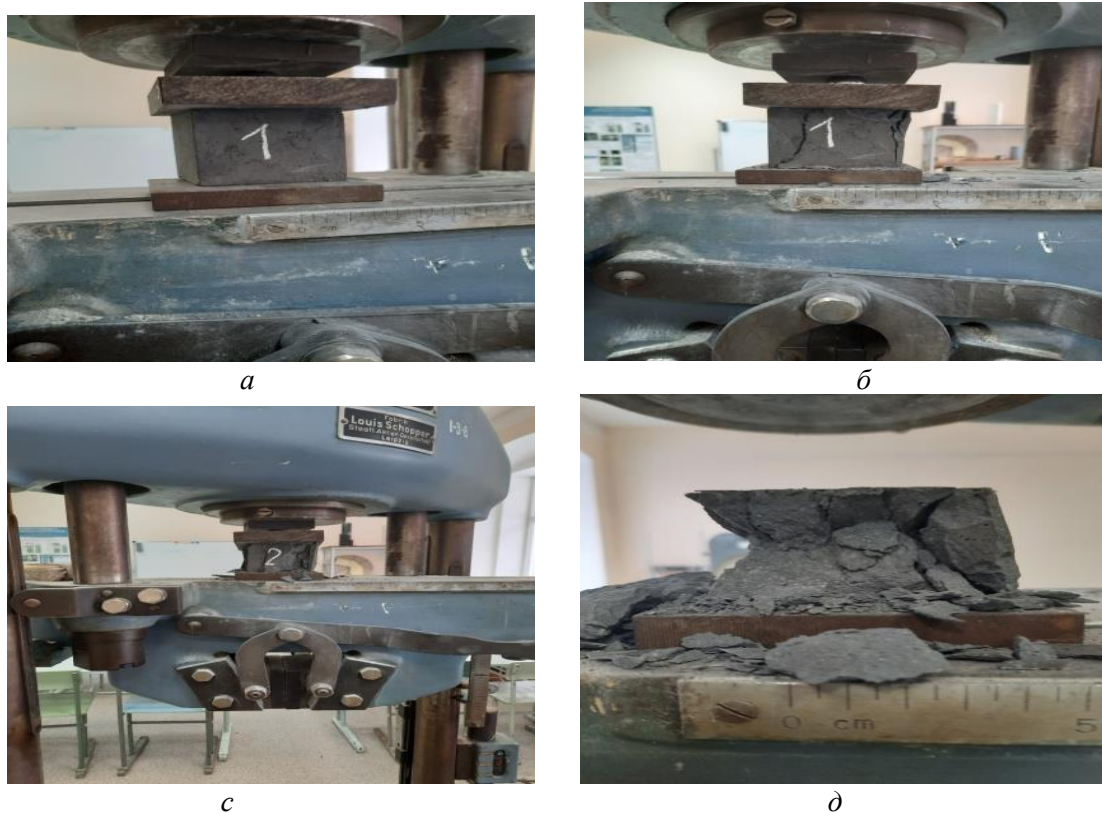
Стадии разрушения образцов из разработанного геополимерного бетона: *а* – испытуемый образец до приложения нагрузки без видимых повреждений; *б* – образец под нагрузкой с образовавшейся первичной трещиной; *с* – частичное разрушение образца; *д* – разрушенный образец
